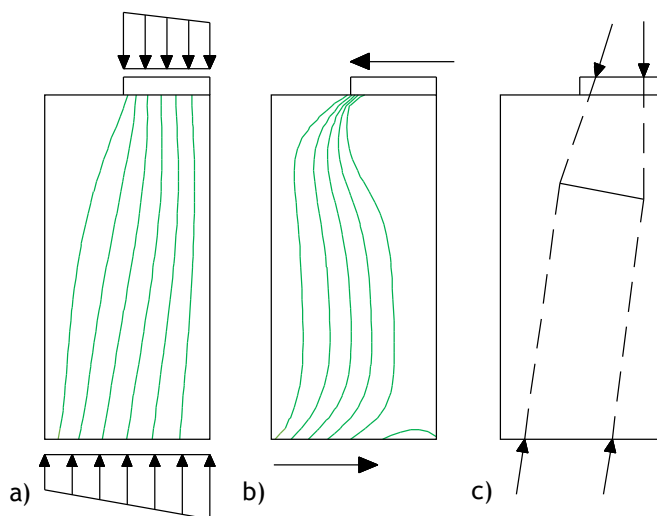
Esquema de ensaio de um prisma carregado com uma placa de carga colocada excentricamente num dos topos e apenas numa porção da secção transversal.
